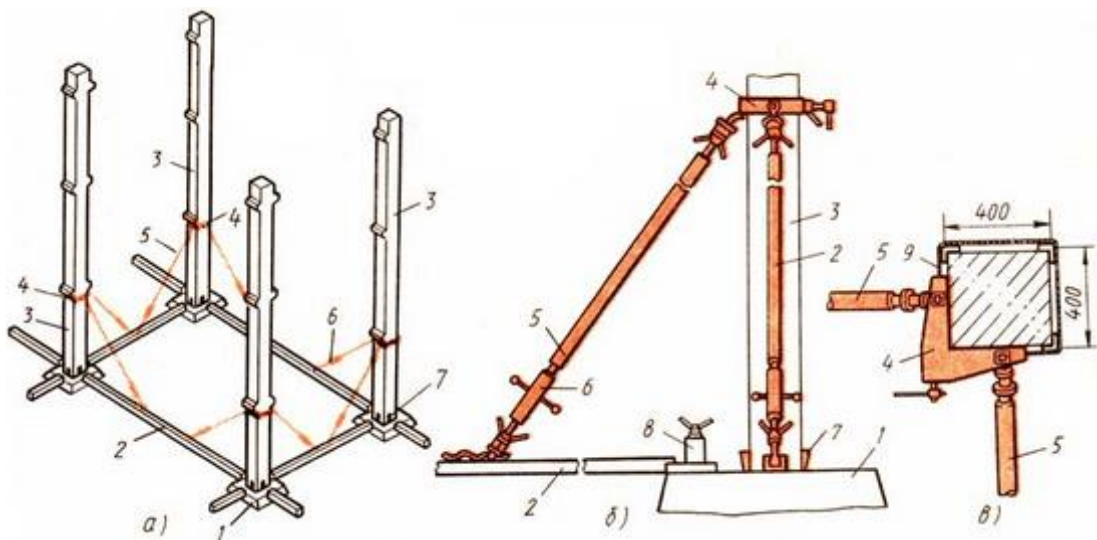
Схеми установки багатоповерхових колон за допомогою комплексу індивідуальних засобів монтажного оснащення: а – розташування колон і пристосувань, б – закріплення колони підкосами, в – хомут для закріплення підкосів до колони; 1 – стакан фундаменту, 2 –
